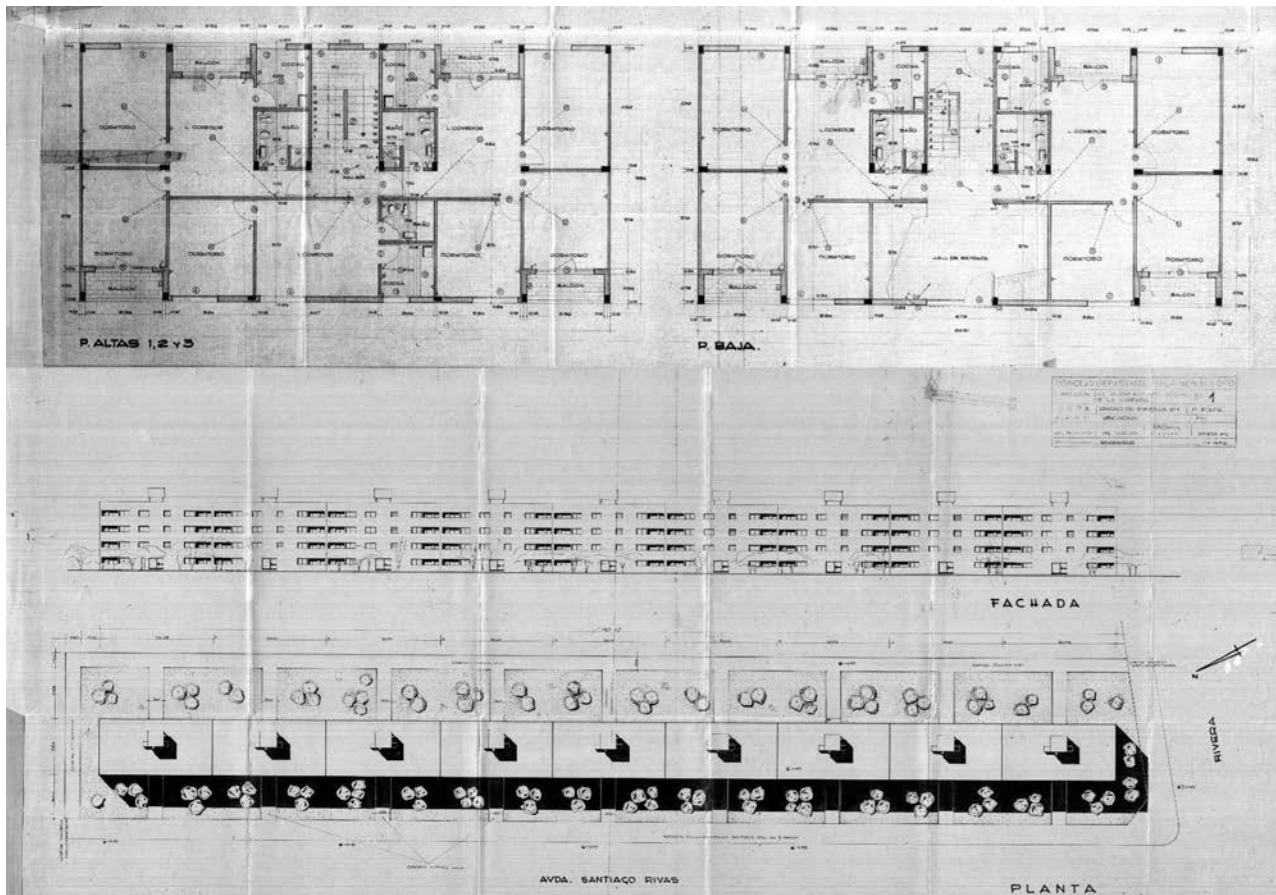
Plantas y alzados del bloque sobre la calle Santiago Rivas perteneciente a la etapa 1 de la Unidad Buqueo. Fuente: Archivo Intendencia de Montevideo, Carpeta 8.
